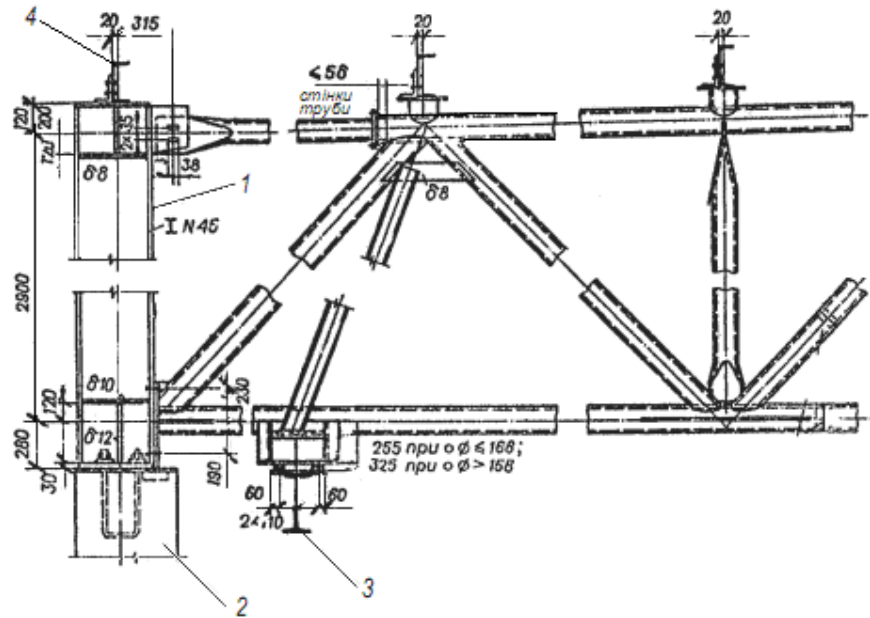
Сталеві ферми з труб: 1 – надпорна стійка; 2 – колона; 3 – балка підвісного крана
